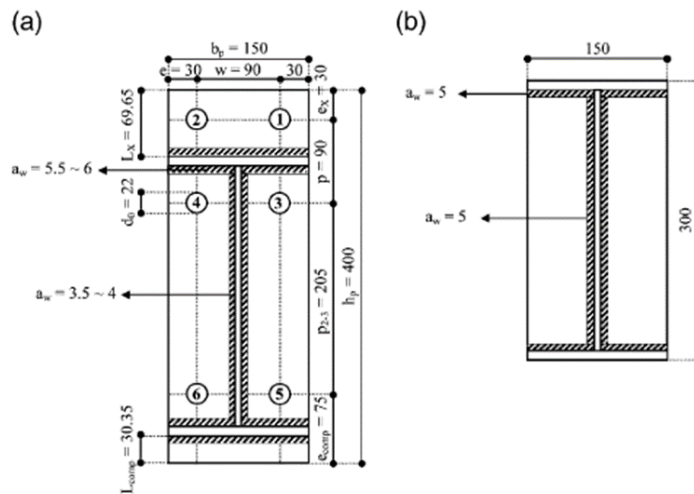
Detalles de los elementos (dimensiones en mm) (a) Detalle de la placa. (b) Detalle del refuerzo
